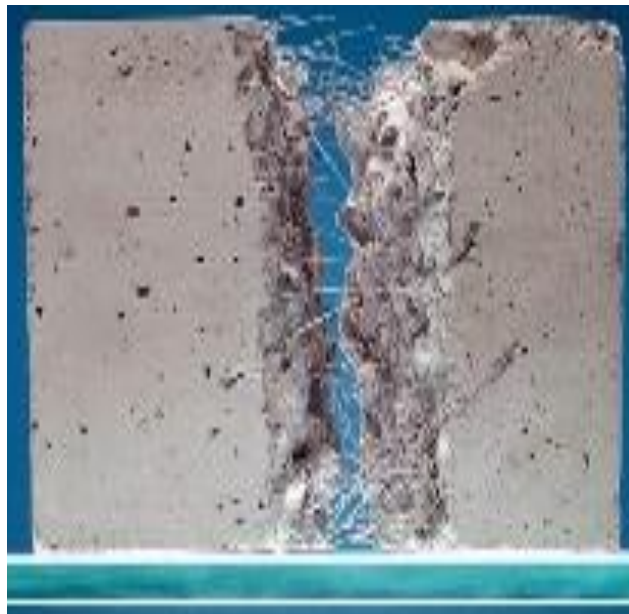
concreto GRC reforzado con fibra de vidrio. Extraída con fines didácticos:
